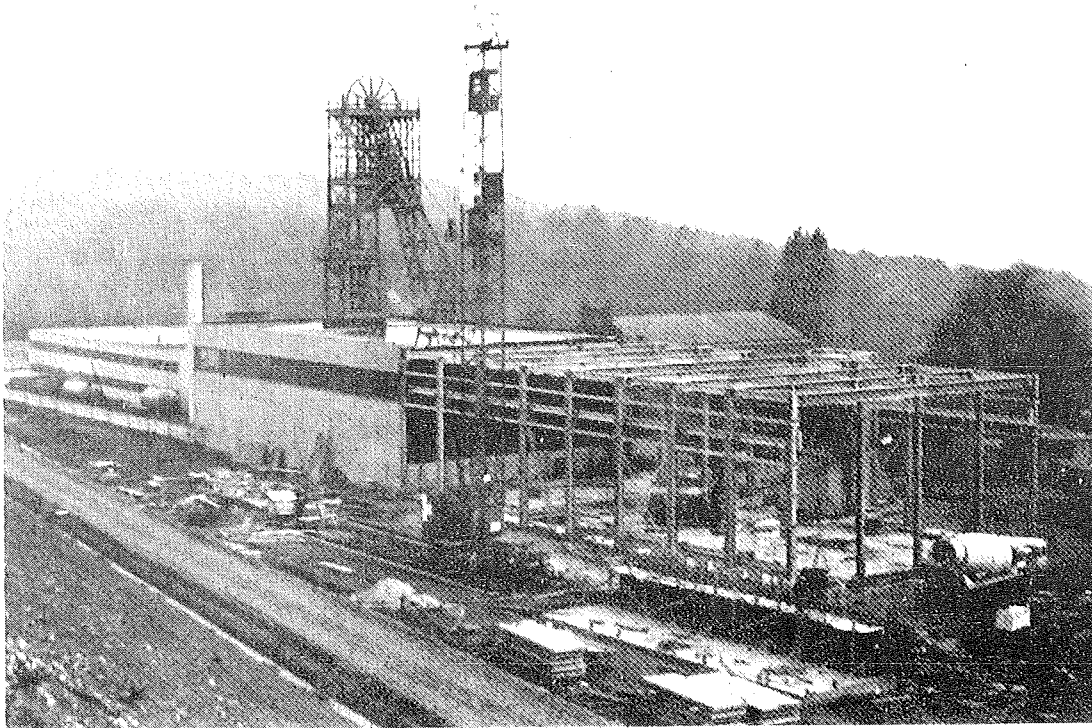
Das Stahlgerüst der Schachthallenerweiterung ist fertiggestellt
